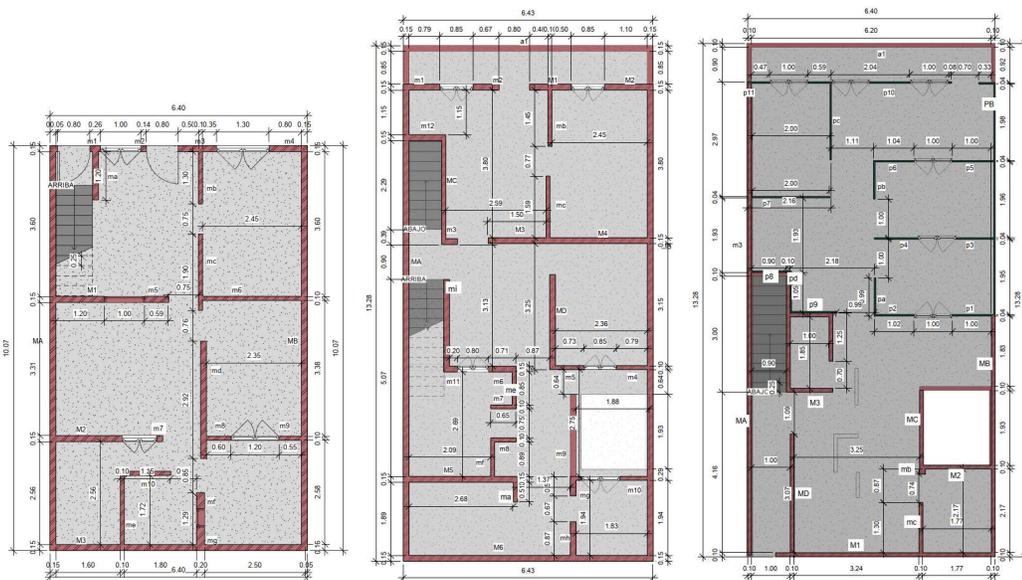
Vista de la planta del nivel 1 2 y3 (de izquierda a derecha). Fuente: elaboración propia
